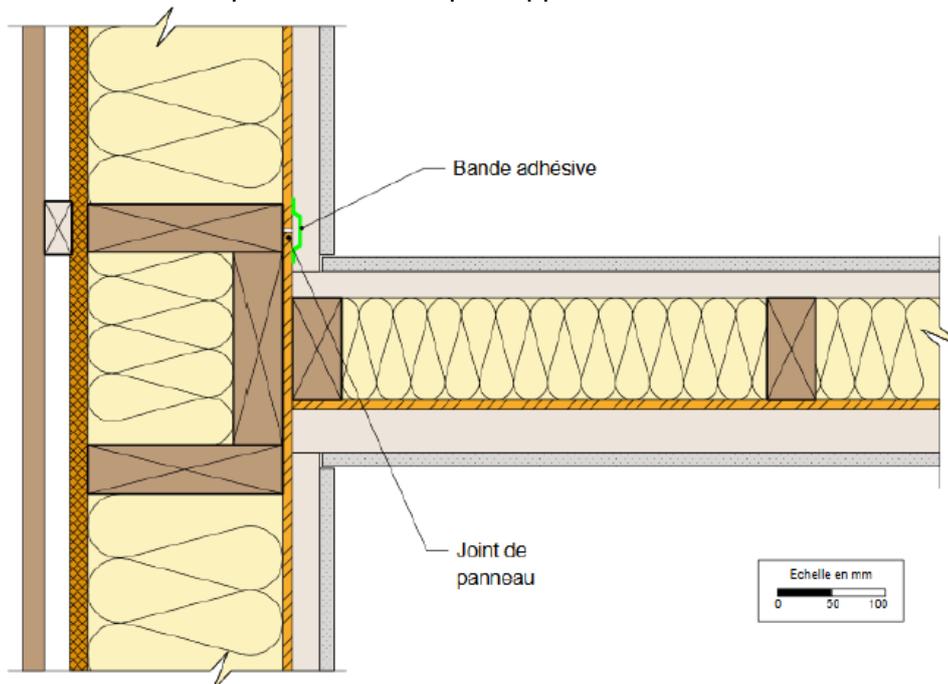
Exemple d'une liaison mur intérieur porteur avec mur extérieur (coupe horizontale)
